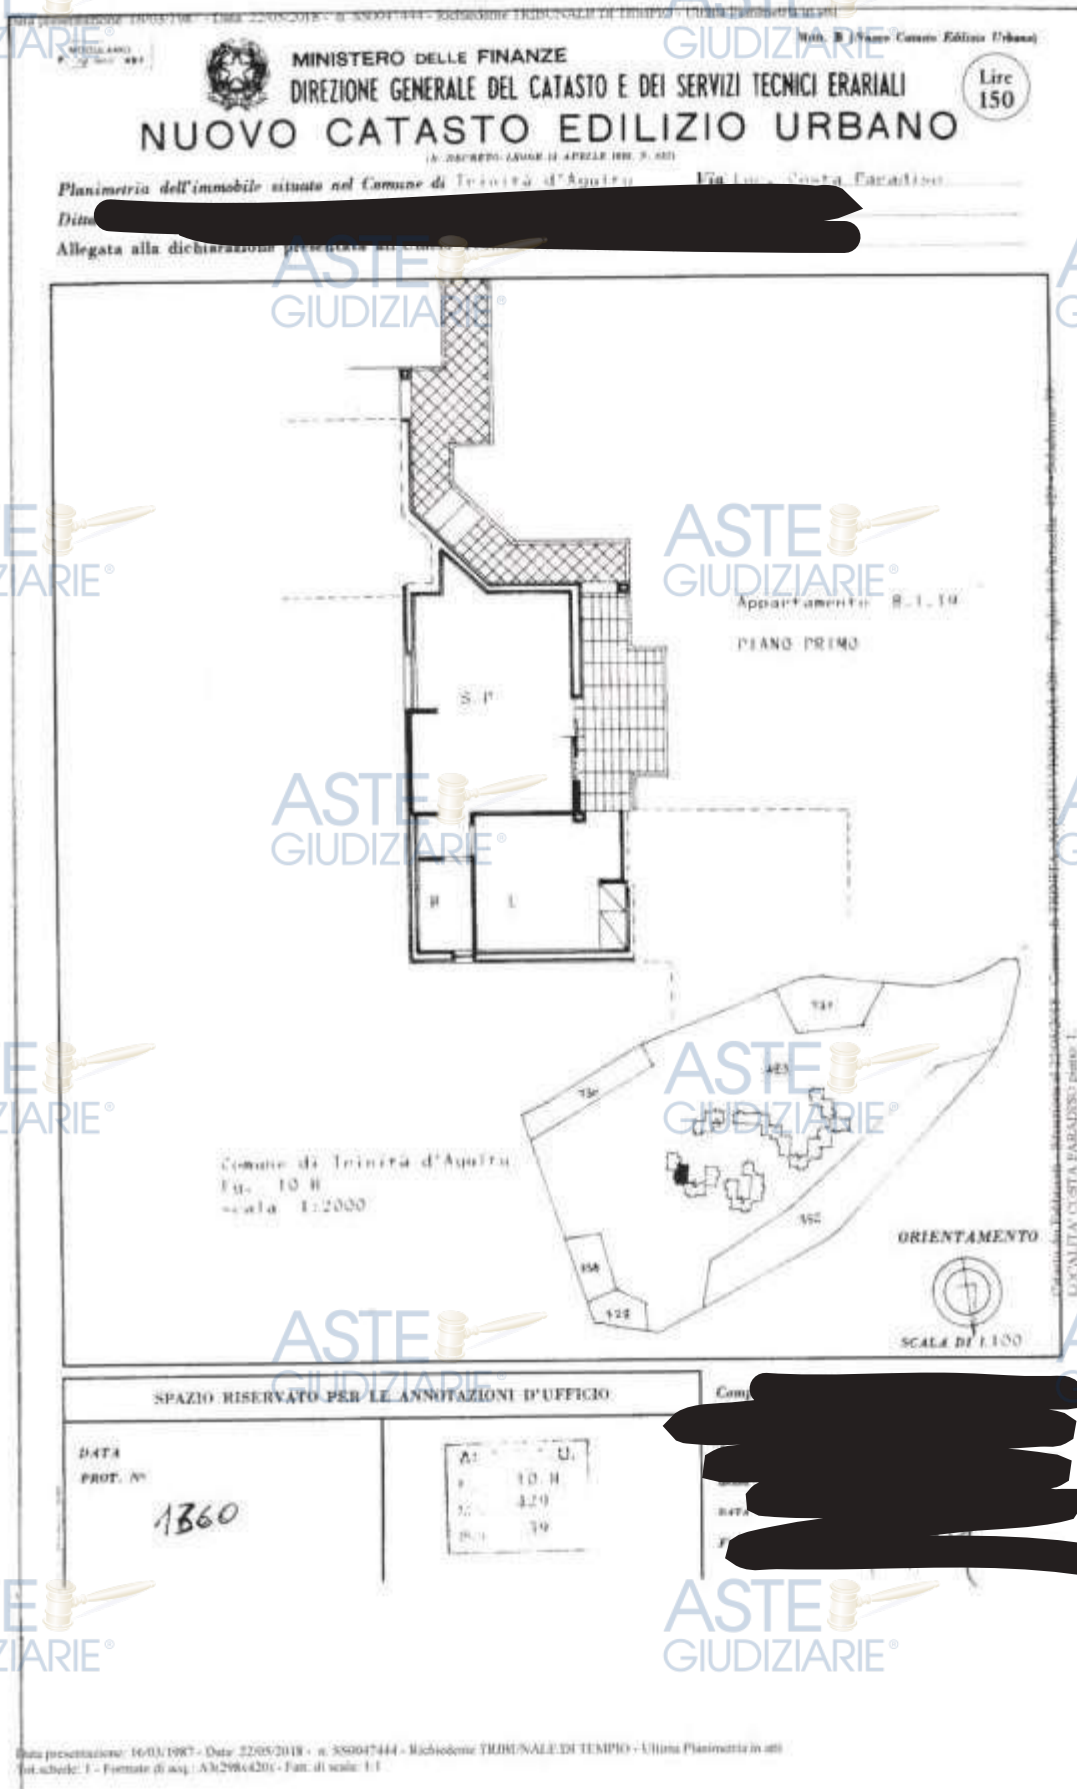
Visura planimetrica catastale originaria Fig. 10 Part. 429 Sub 39
